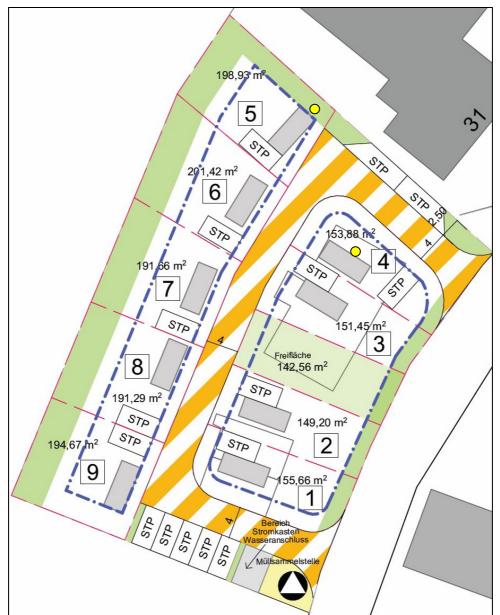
Vorentwurf Bebauungsplan "Tiny-Houses" (Ausschnitt) O Immissionsorte
